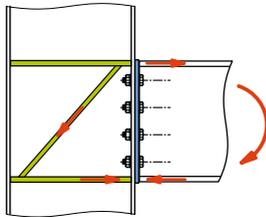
Renforcement du panneau d'âme par un raidisseur diagonal
